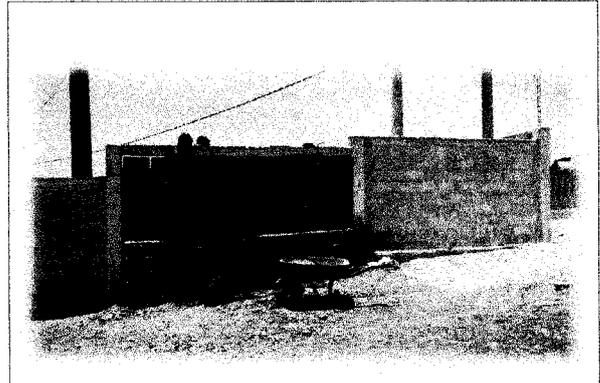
ASENTADO DE BLOQUES DE CONCRETO
